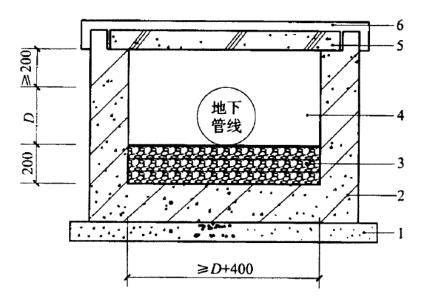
抗渗钢筋混凝土管沟防渗层示意图
